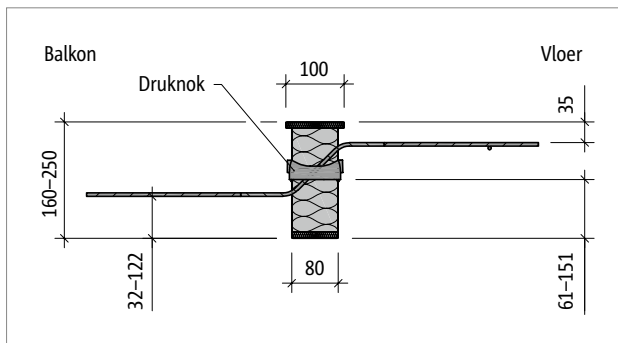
Schöck Isokorf® T type Q-E: detail B
